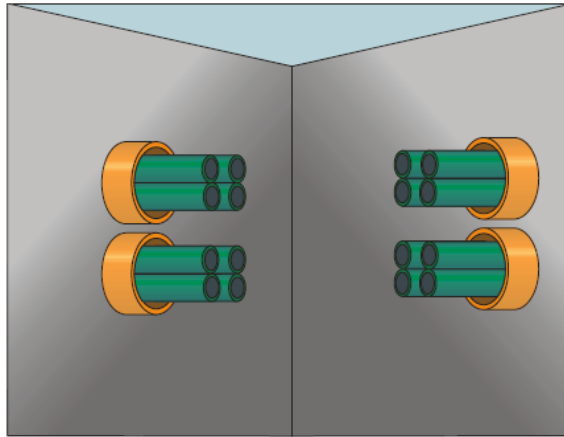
Leerrohre mit installierten „Sub-Ducts“ (Unter-Leerrohren) <sup>27</sup>
